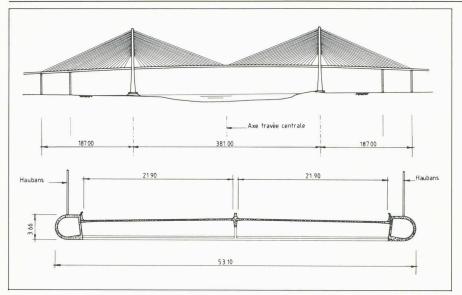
Pont de Baytown, variante avec bicaissons latéraux.
